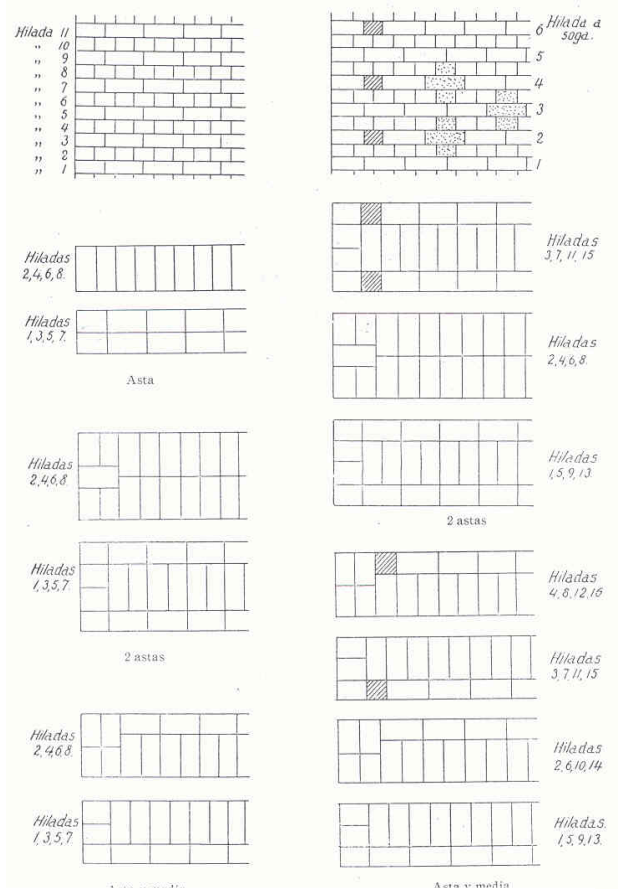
Alzado y organización en planta para distintos espesores de aparejos inglés y belga, solución trabada. (Esselborn 1928, 1: p.77)
